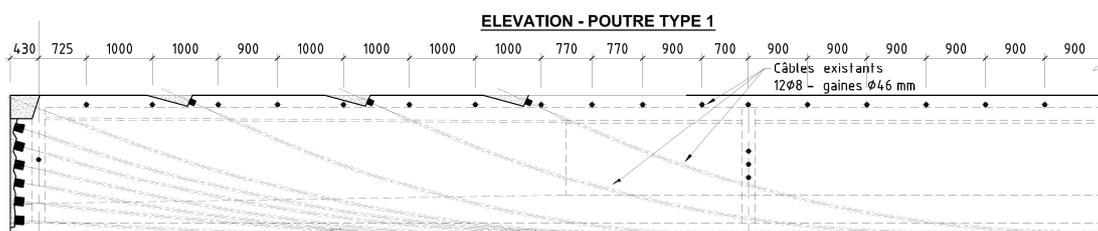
élévation d'une poutre courante – tracé des câbles de précontrainte existants
